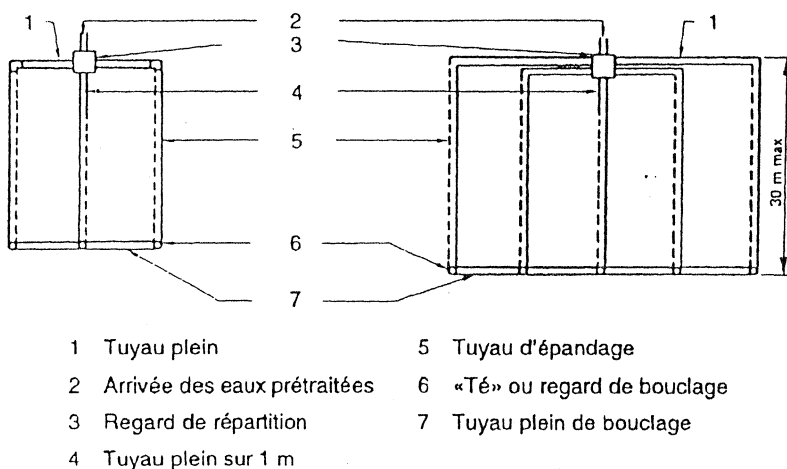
Vues en plan ; exemples à 3 et 5 tranchées
